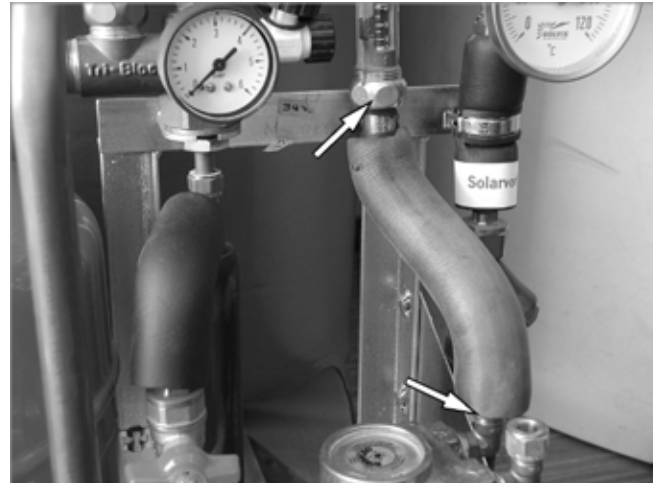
Rohr an Pumpe (Druckseite) montieren
